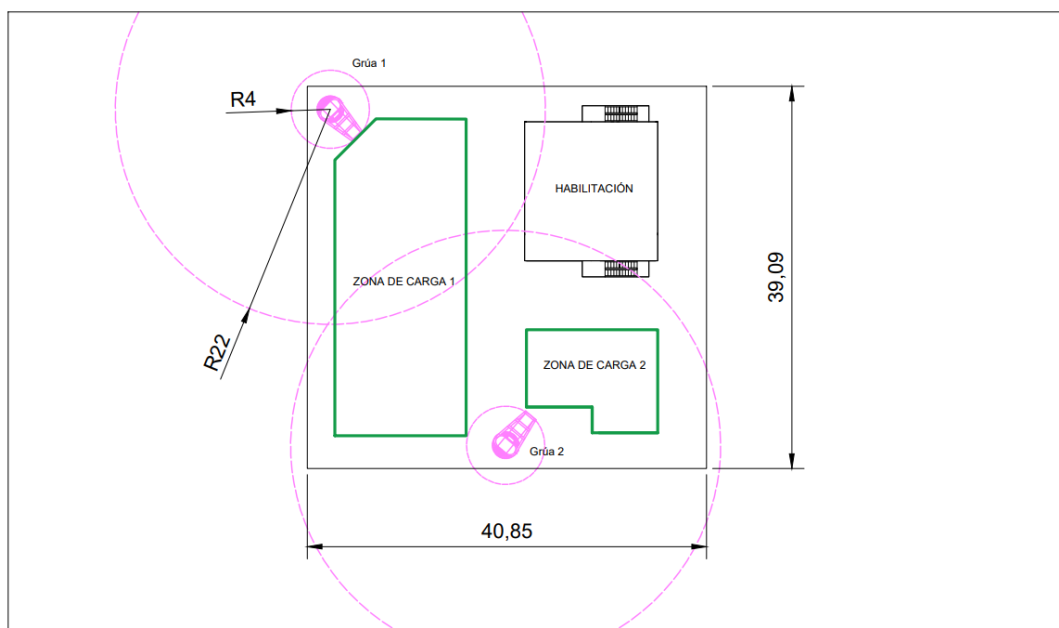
Dimensiones finales de la cubierta (cotas en m)
